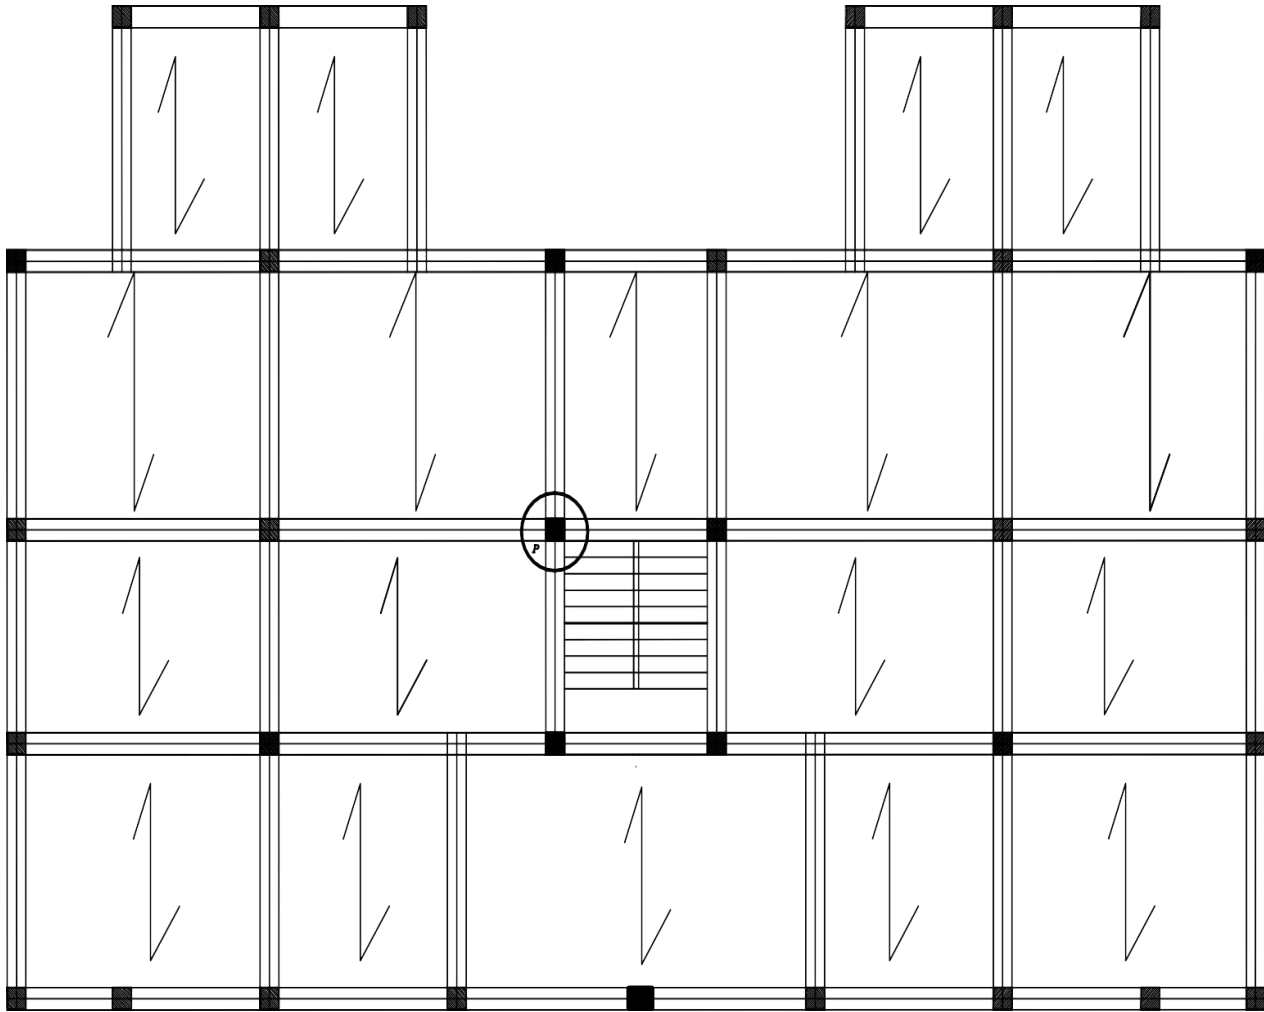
Vue en plan d'identification des poteaux de la descente de charges.
